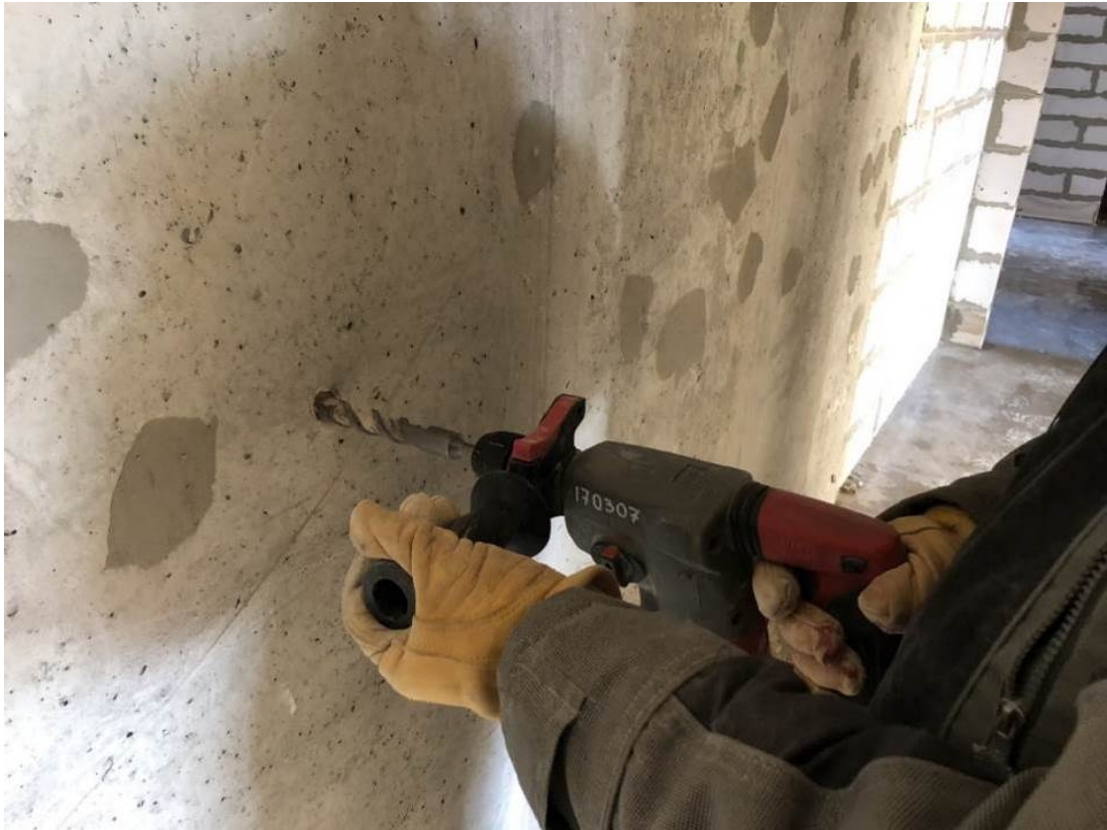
Сверление отверстия в монолитной железобетонной стене
